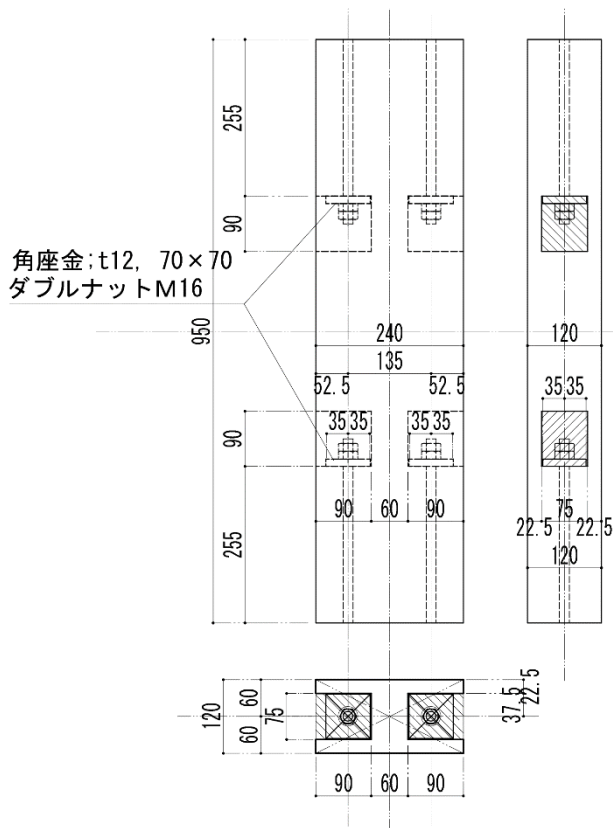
試験体\_No. 16: TBJ-Z600-12/70\_JC65EW 試験体
